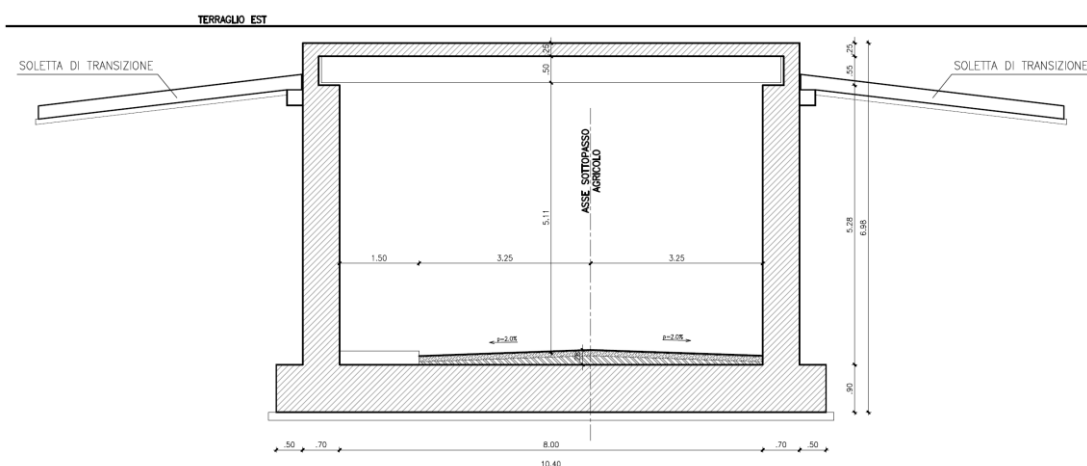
Sezione trasversale del sottopasso agricolo
